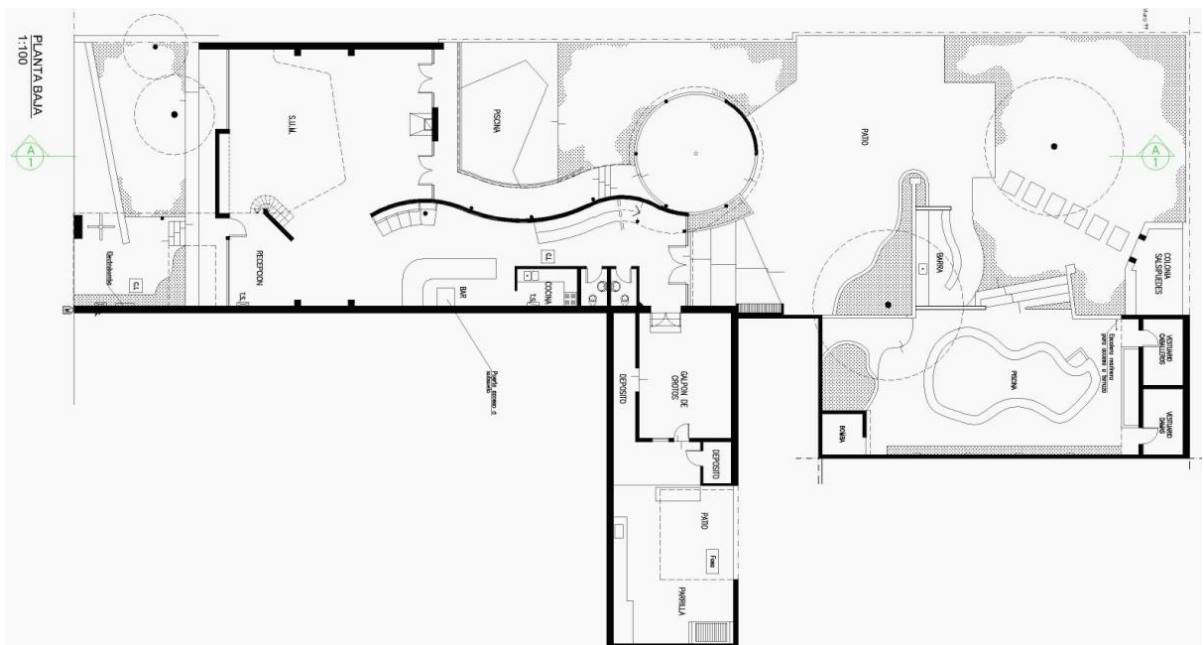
Planos nuevos de EFDA, planta baja. Relevamiento del PI 12N001
